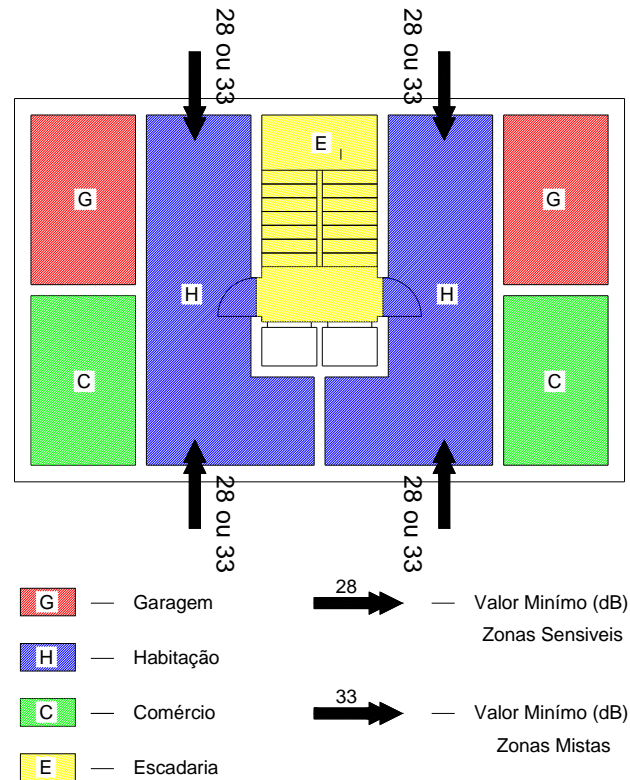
6 - Planta com valores mínimos para Fachada ($D_{2mnT,w}$)
